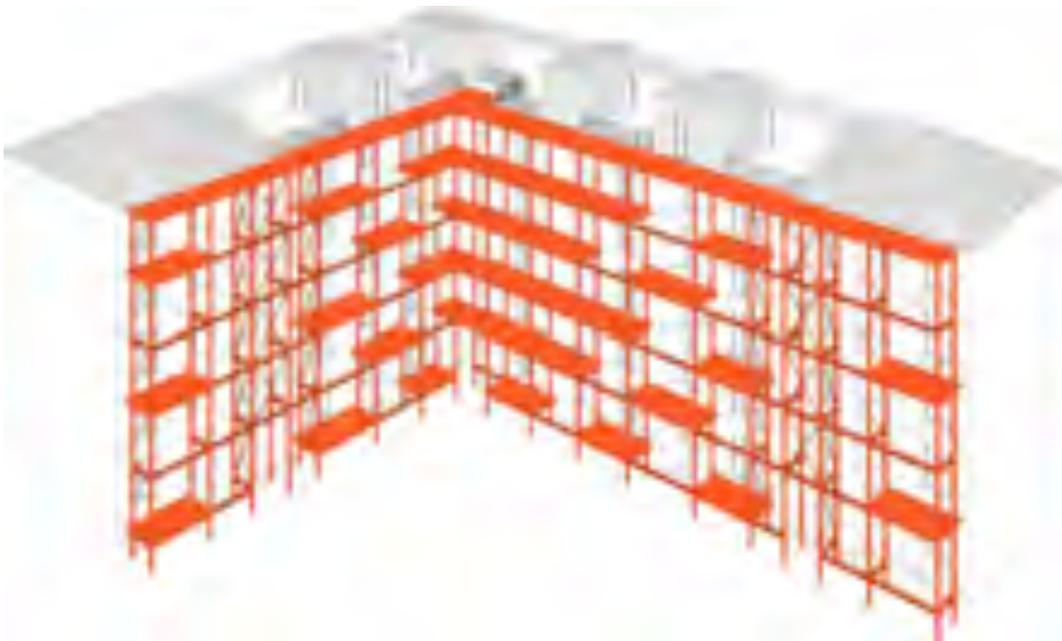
Vista assonometrica dell'edificio con la nuova struttura in aggiunta
